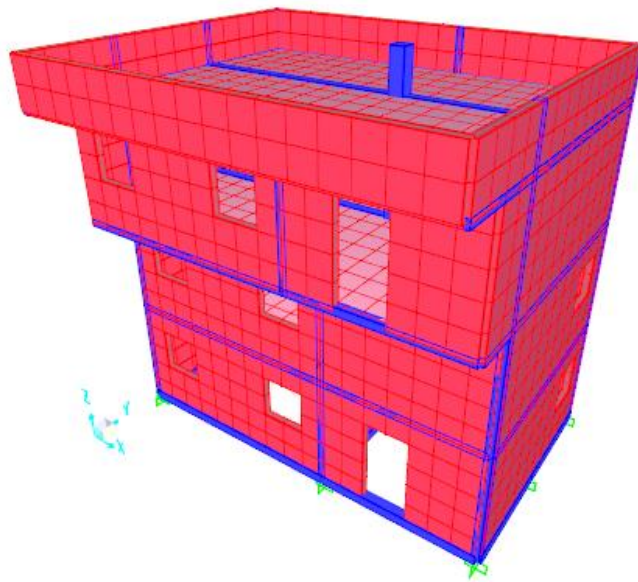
Vista de fachada de vivienda #1 en SAP2000.
